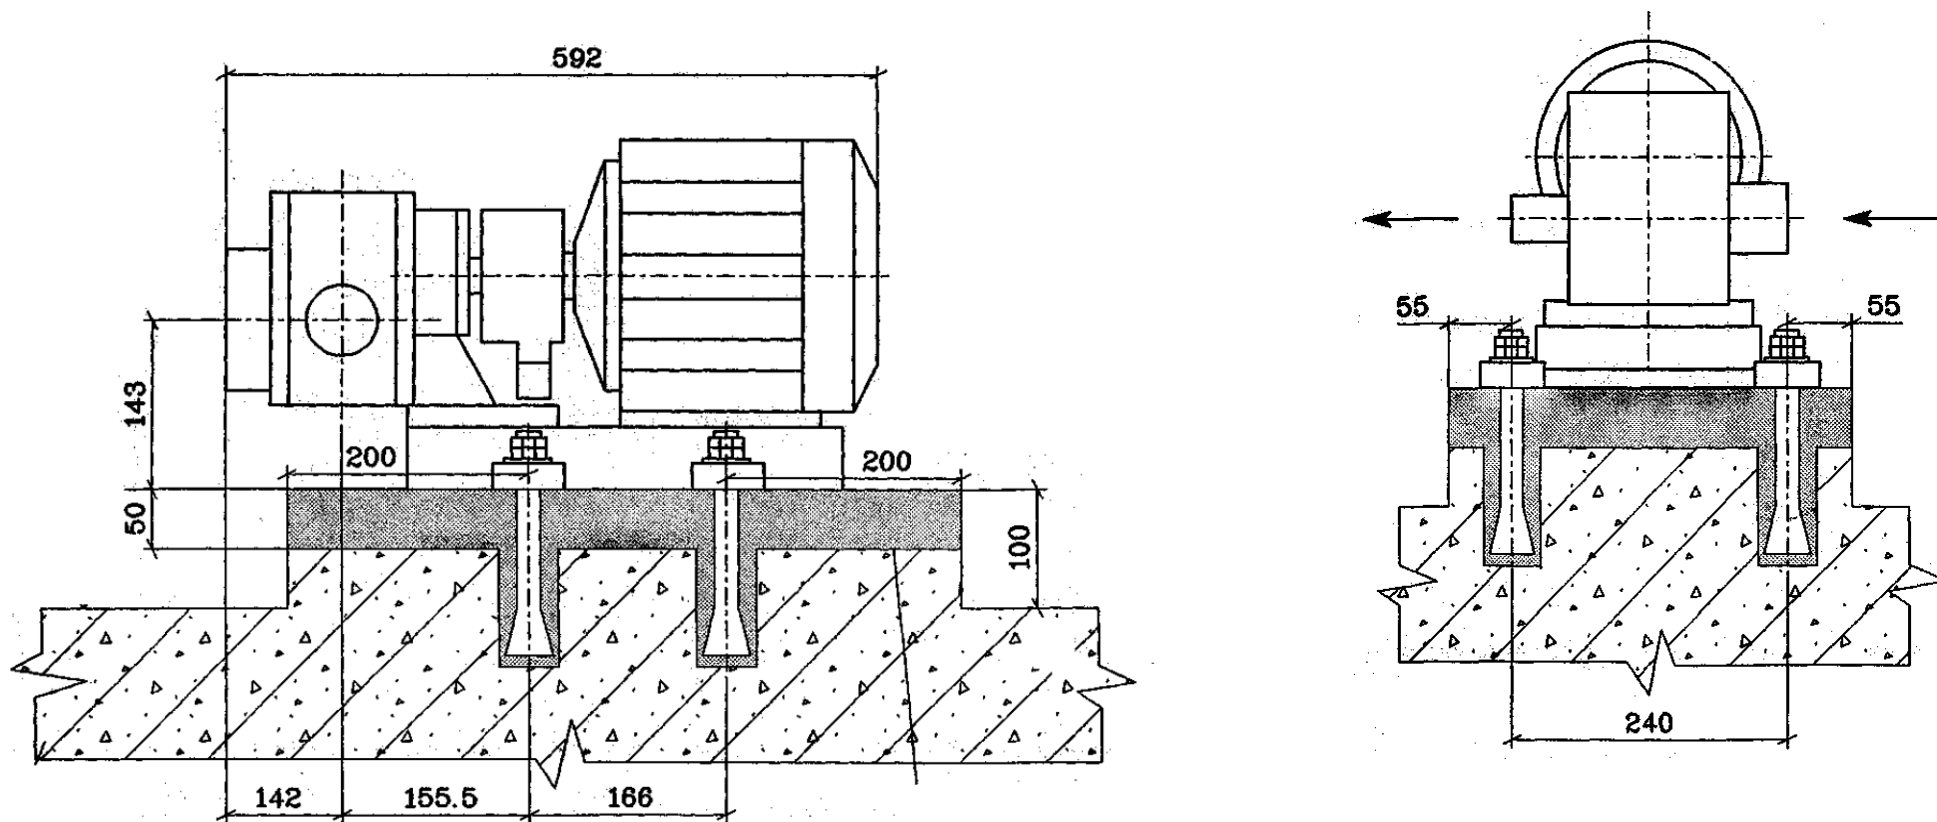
Габаритный чертеж насоса-дозатора гидразина LDN11AP001, LDN12AP001
